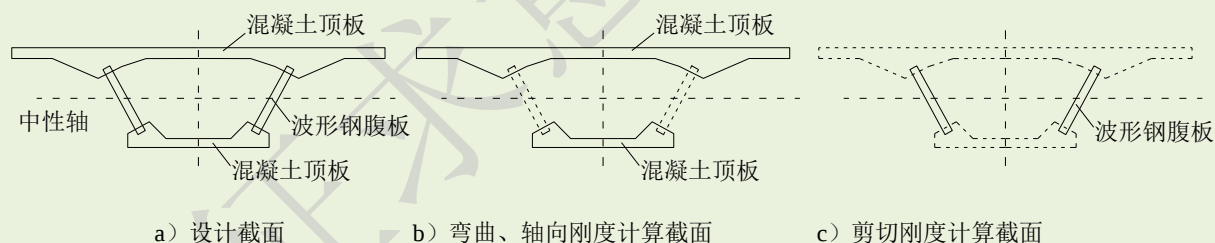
波形钢腹板预应力混凝土组合梁有效截面示意图
